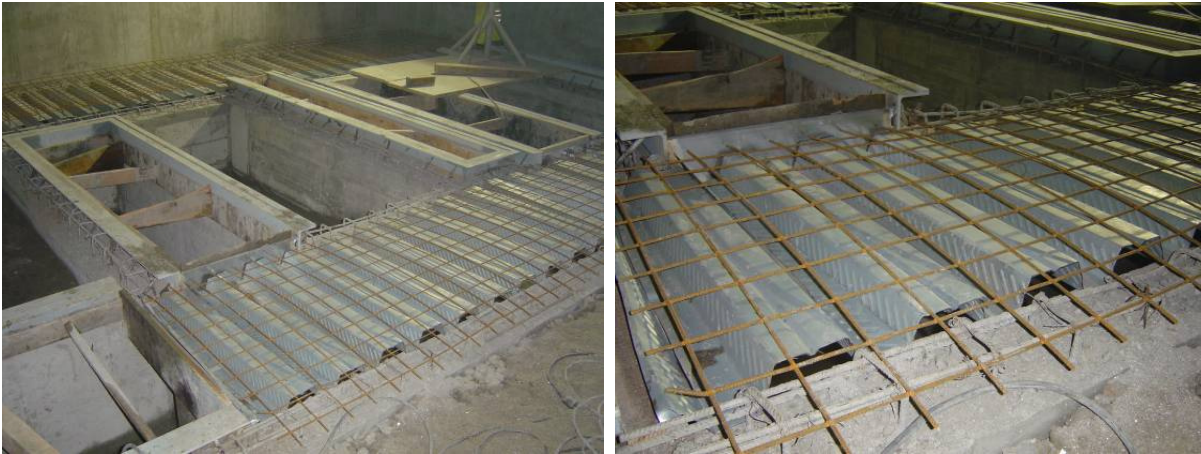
Aplicação de armadura de reforço na zona do passadiço metálico.
